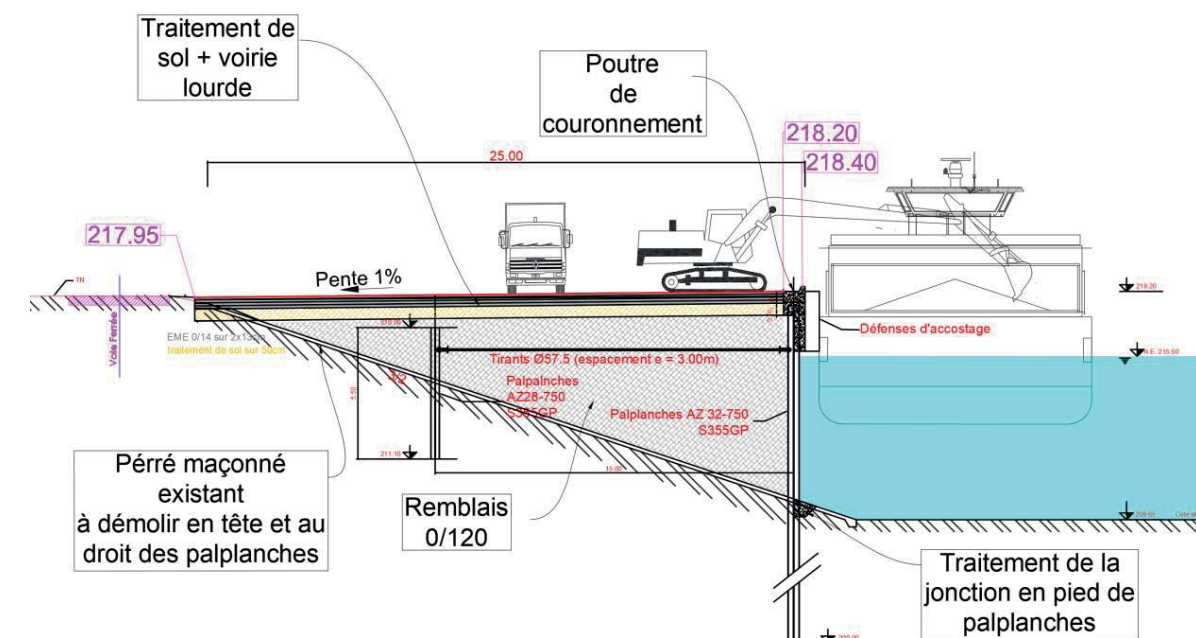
Coupe sur quai palplanches -palplanches avec contre rideau
